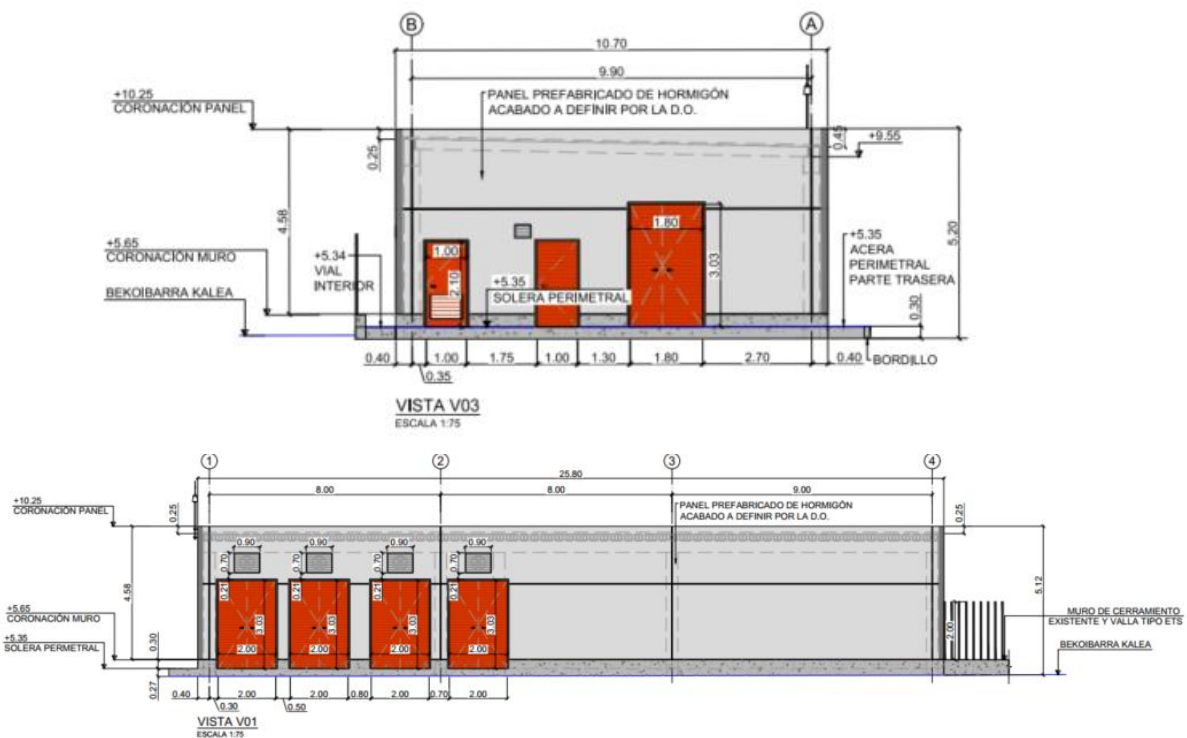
Alzados de fachada de la nueva subestación de Gernika.
